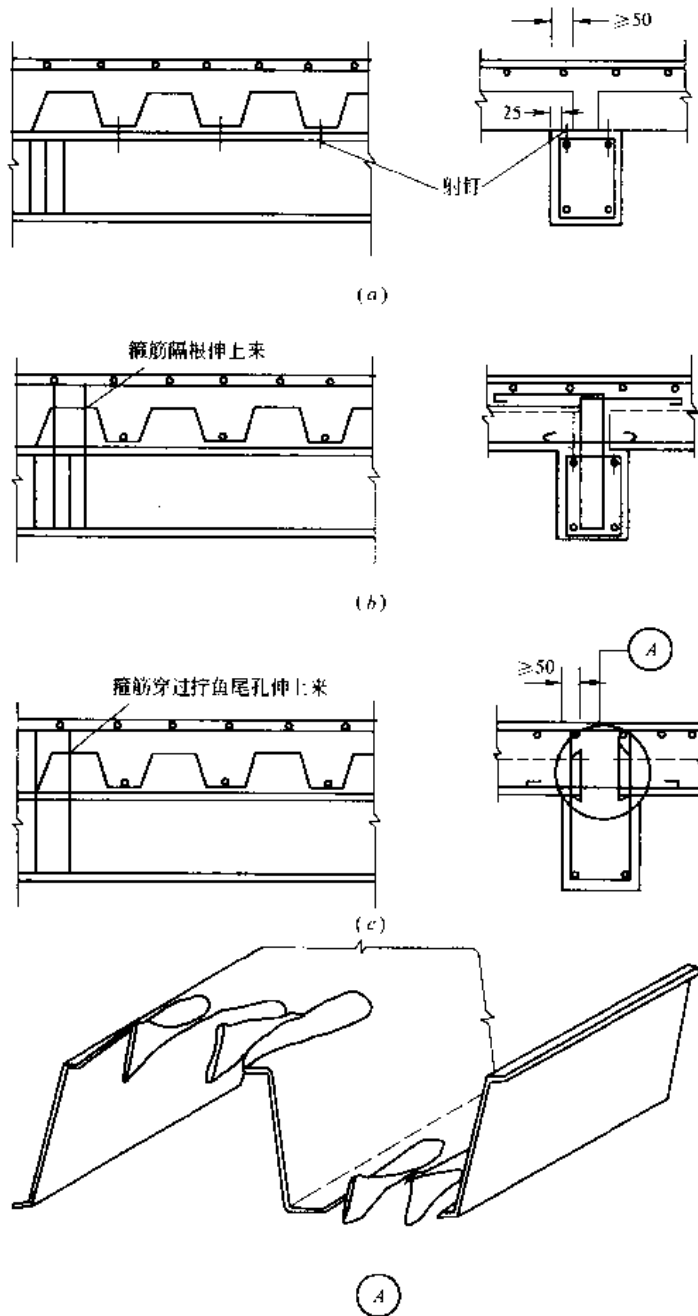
组合板支承于钢筋混凝土结构体系的端部锚固方法
